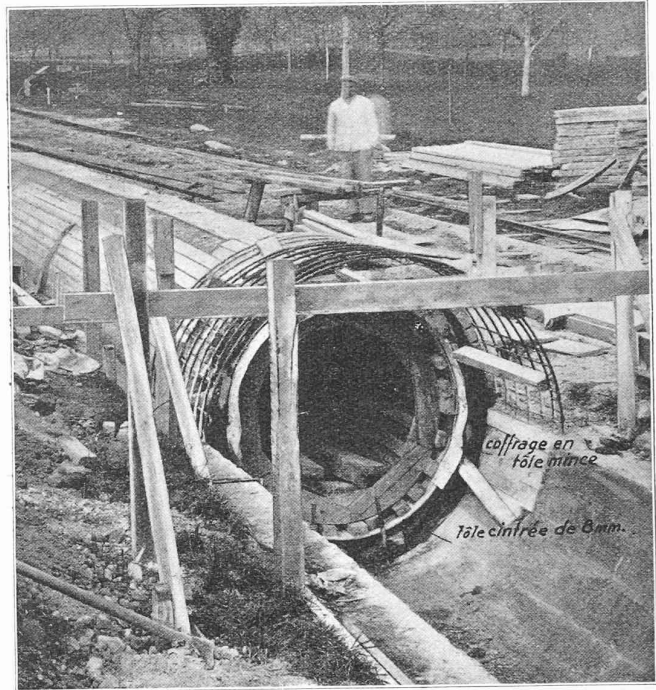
Conduite forcée après le décoffrage extérieur. Vue du coffrage intérieur.
